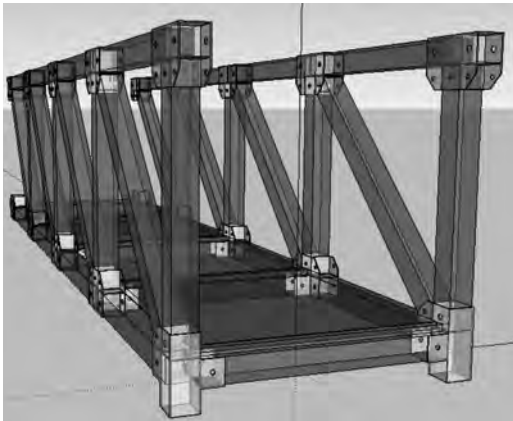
Tipos de conexiones metálicas empleadas en la construcción del puente.
